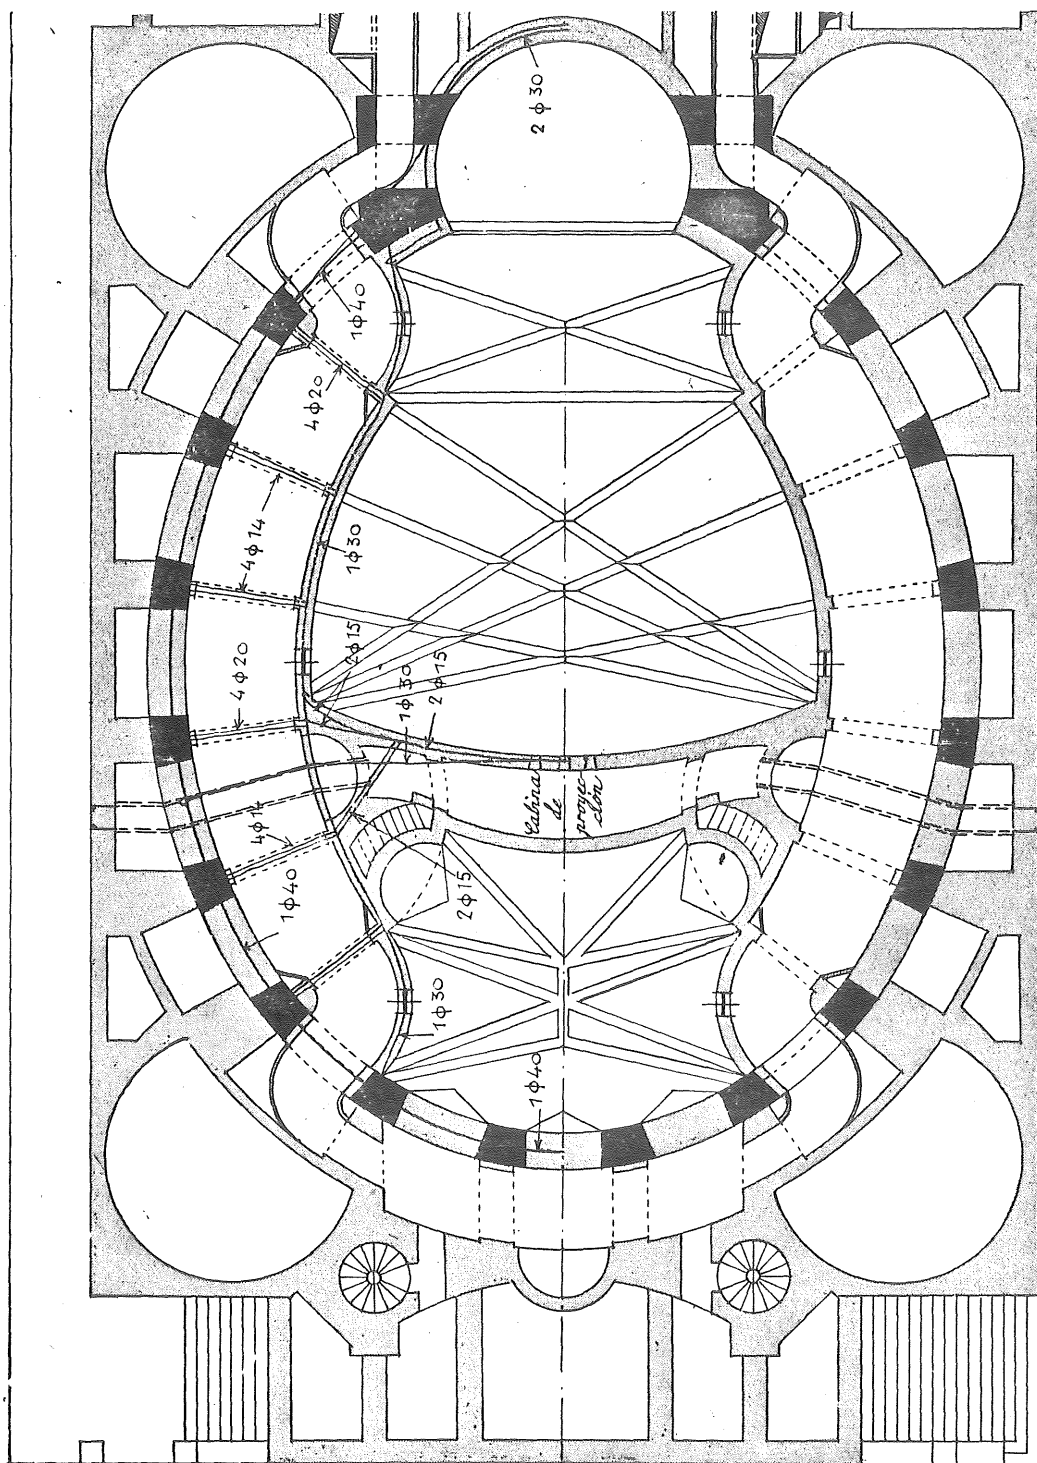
Bóvedas de la planta inferior. Escala 1/192.
